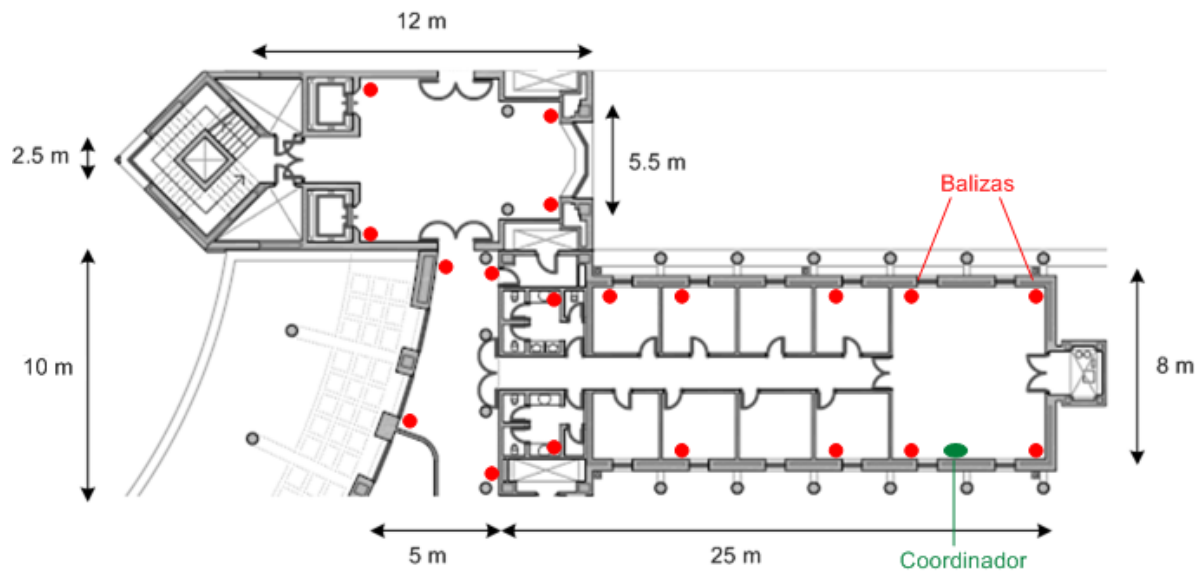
Plano de la estructura RF propuesta en la 3ª planta del Departamento de Electrónica, Edificio Politécnico de la Universidad de Alcalá
